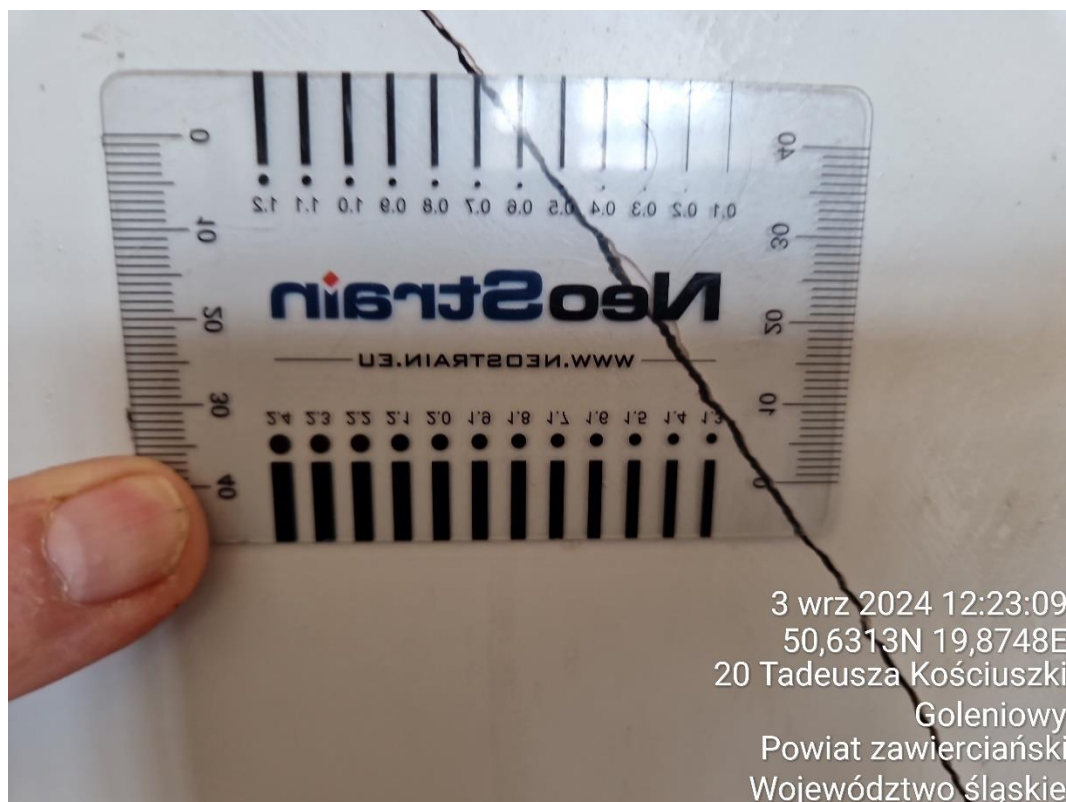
Widok zarysowań elewacji południowej od strony wschodniej ściany szczytowej.
